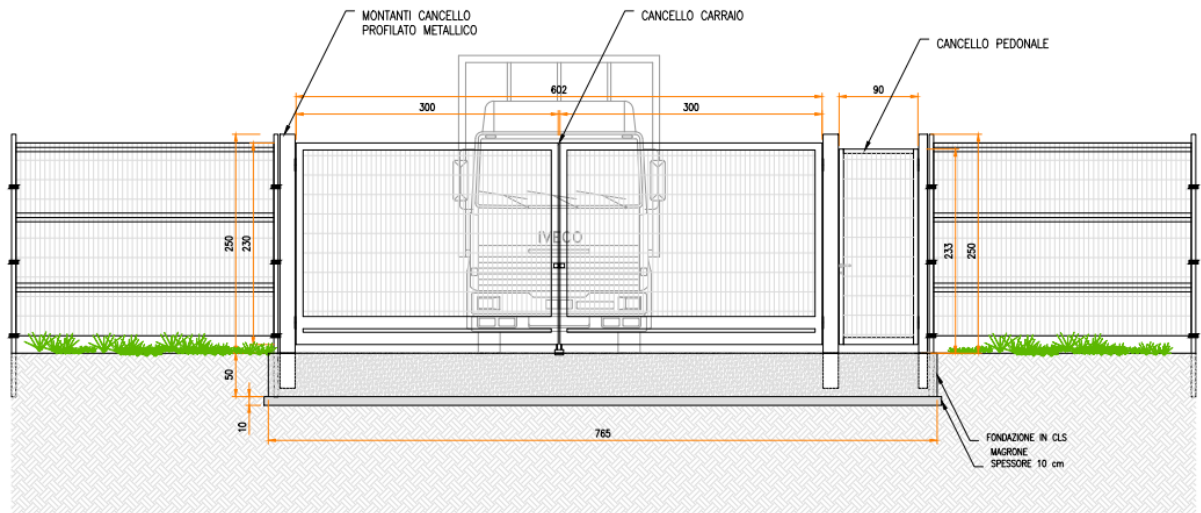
Sezione longitudinale accesso carraio e pedonale
